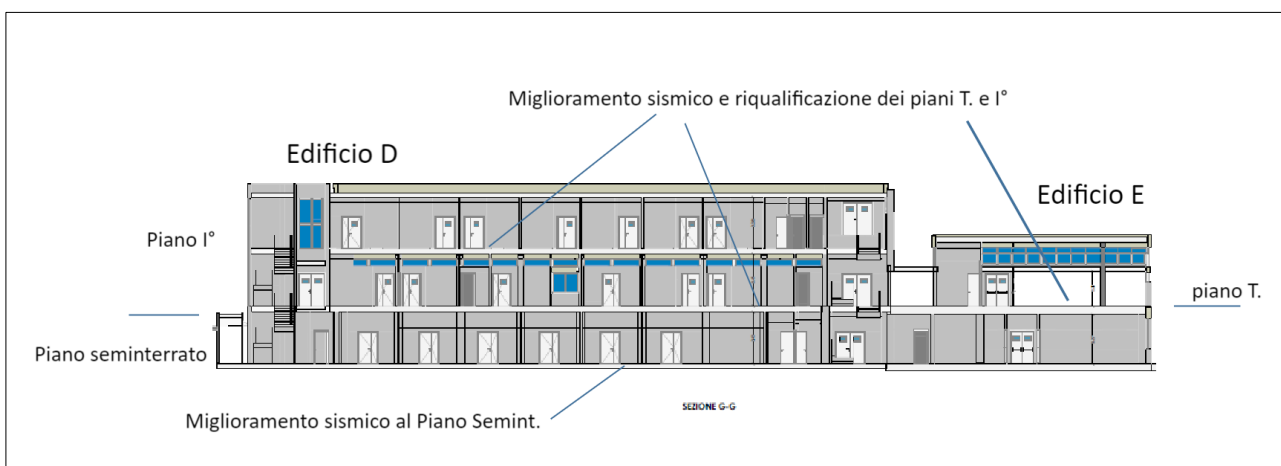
Sezione stato di fatto edifici D ed E (dal rilievo del geom. Giuseppe Morena)
